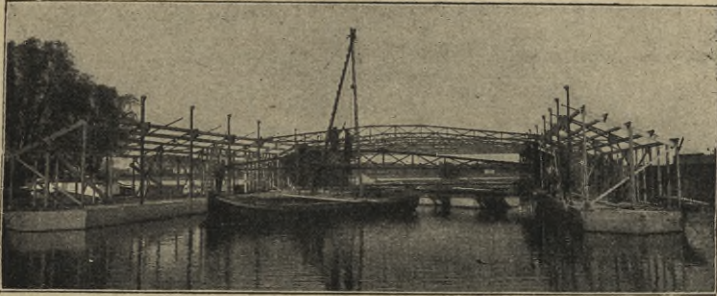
Badeanstalt auf Eisenbetonpontons während des Baues.
